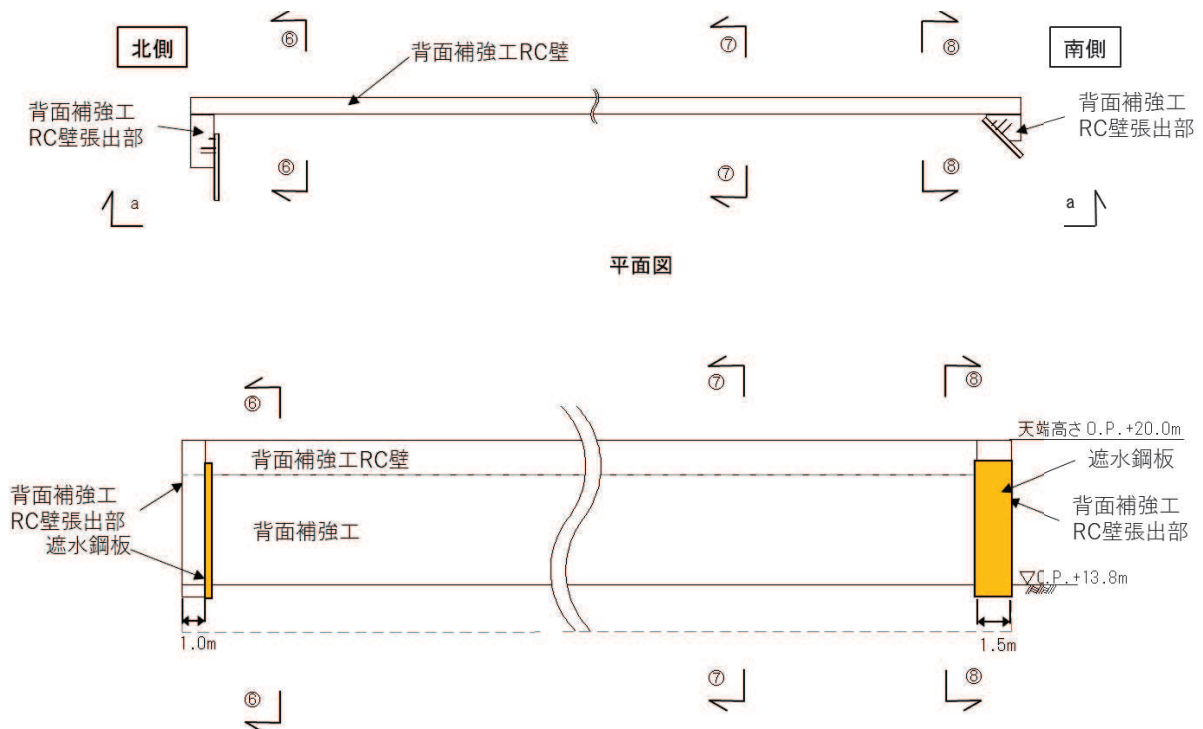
(1) 止水ライン⑥⑦⑧の構造概要(平面図, 正面図)
